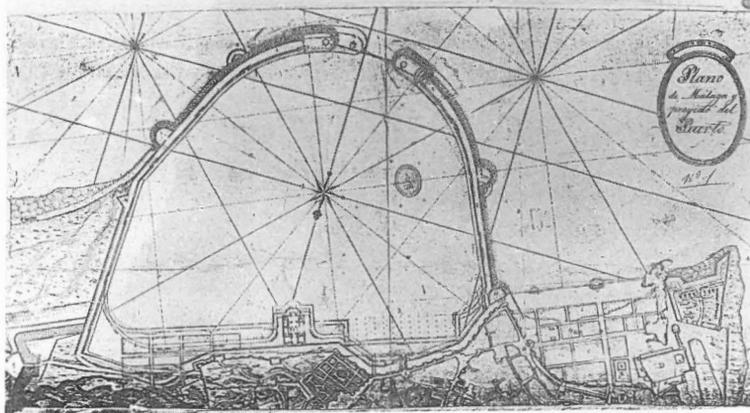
Plano de la zona sur de Málaga y proyecto de Puerto.
